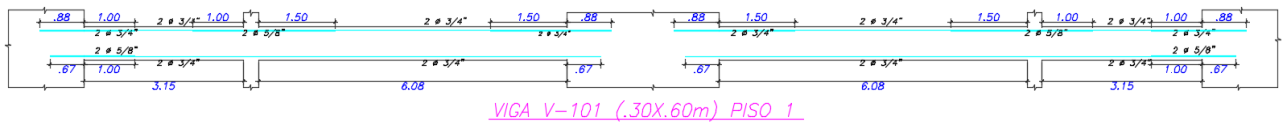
Esquema de colocación de aceros de refuerzo.
